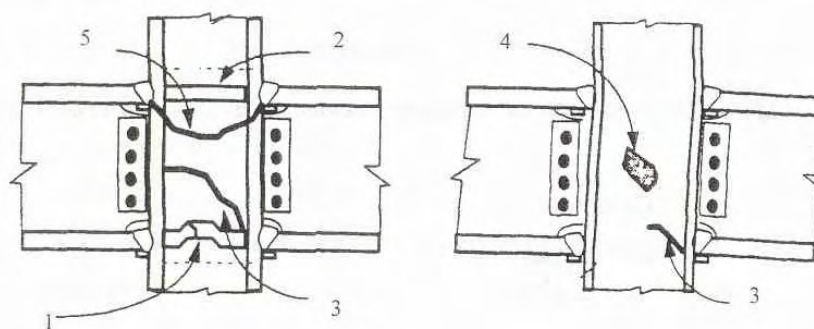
Caracterización de los daños típicos en conexiones viga-columna
